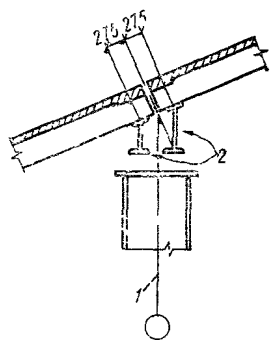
Раздельные балки перекрытия пролетного строения при монтаже его блоками, собранными внизу
